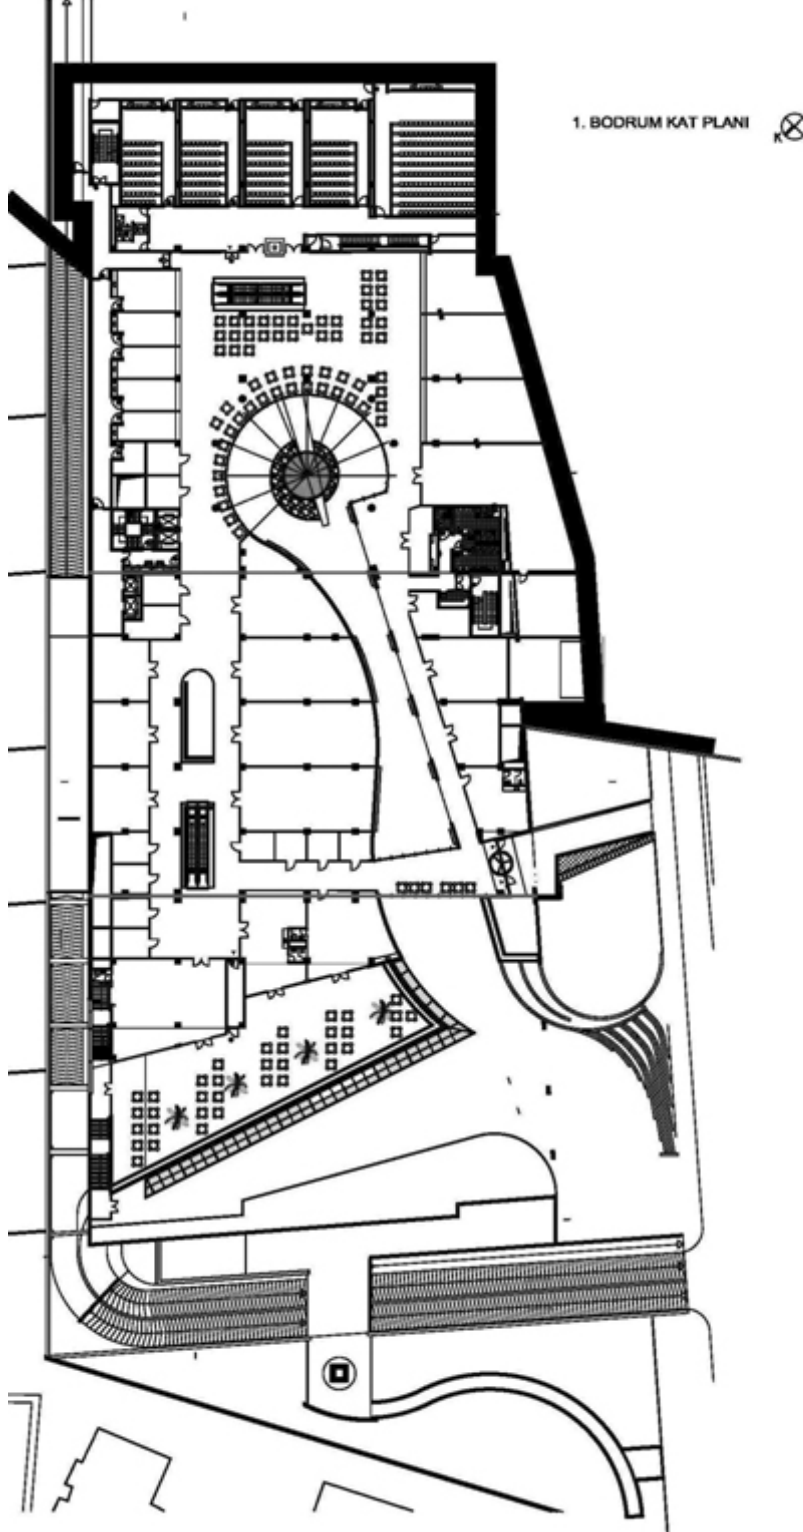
Maltepe Alışveriş Merkezi vaziyet planı
